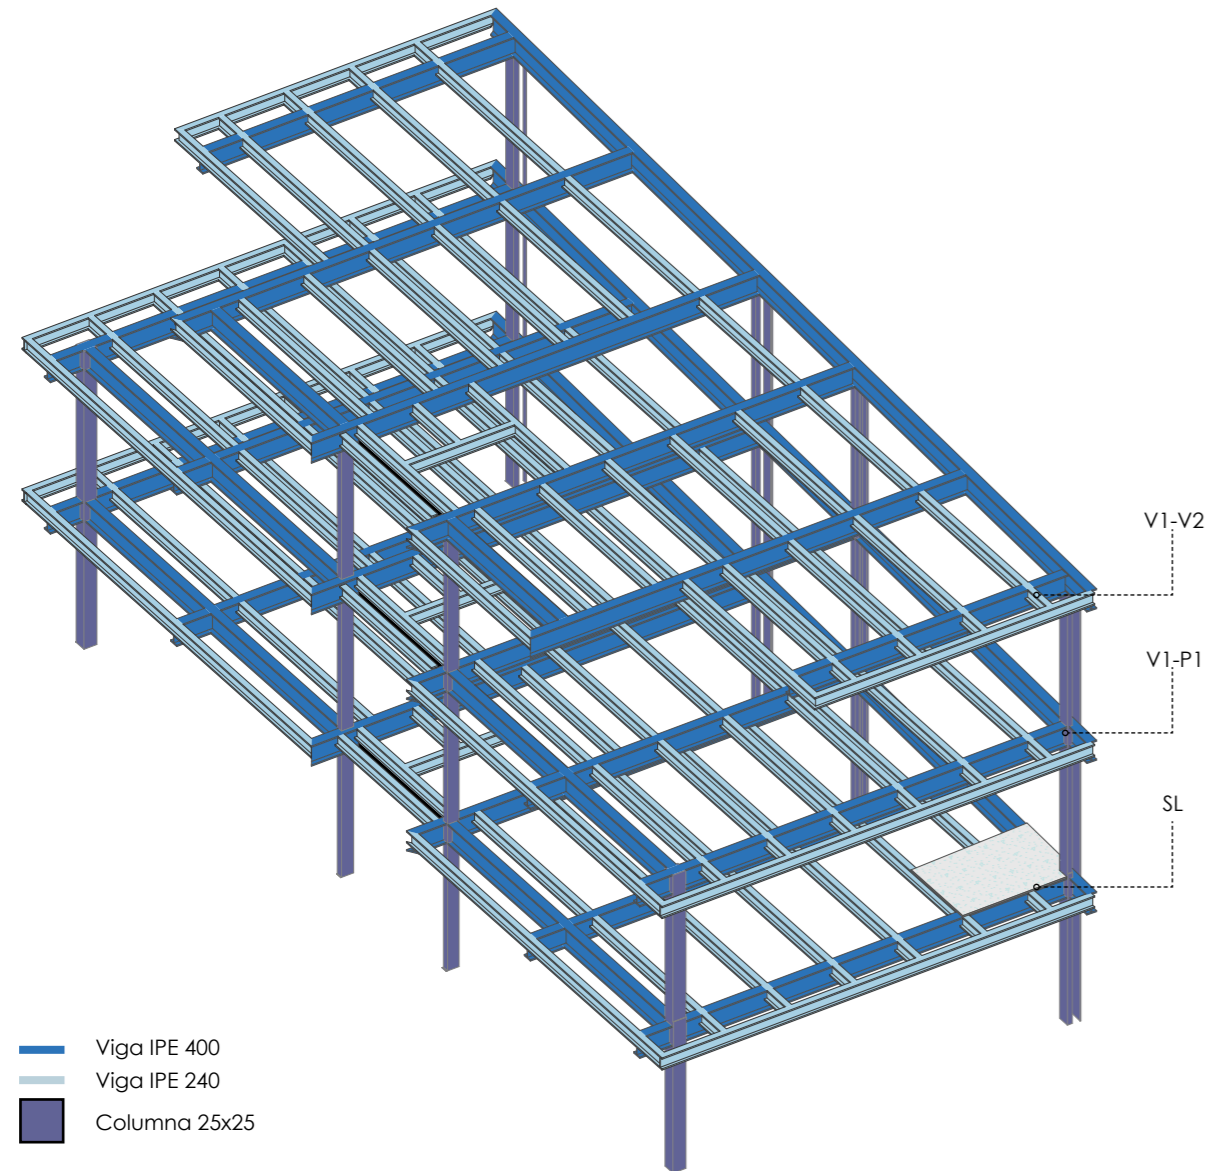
Axonometría Estructural del Bloque B Elaboración propia (2026).
